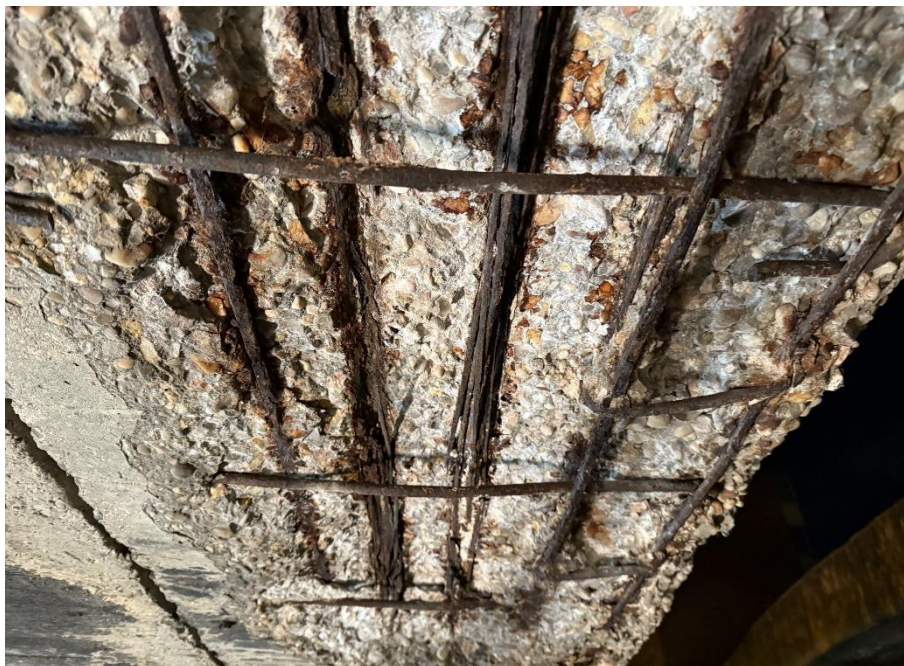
Detalle de pérdida de sección en la viga de borde derecha. Fuente: INES Ingenieros (15/03/2025).
